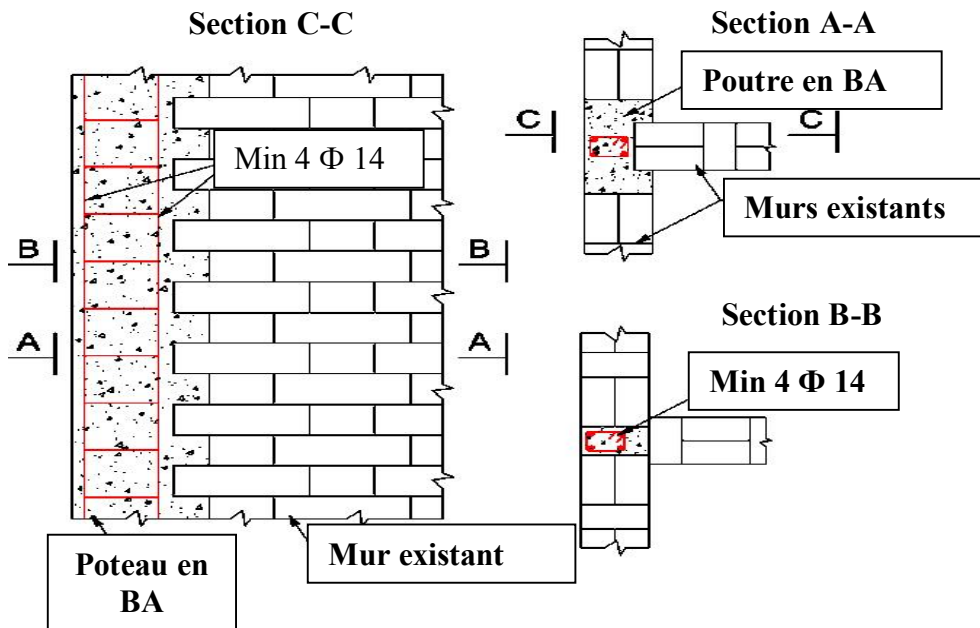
Détail du renforcement d'un mur en maçonnerie avec des éléments en béton armé
